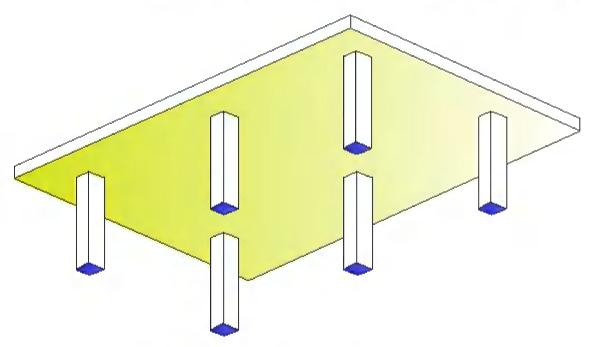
البلاطات المصمنة ذات الاتجاهين Two way solid slabs
